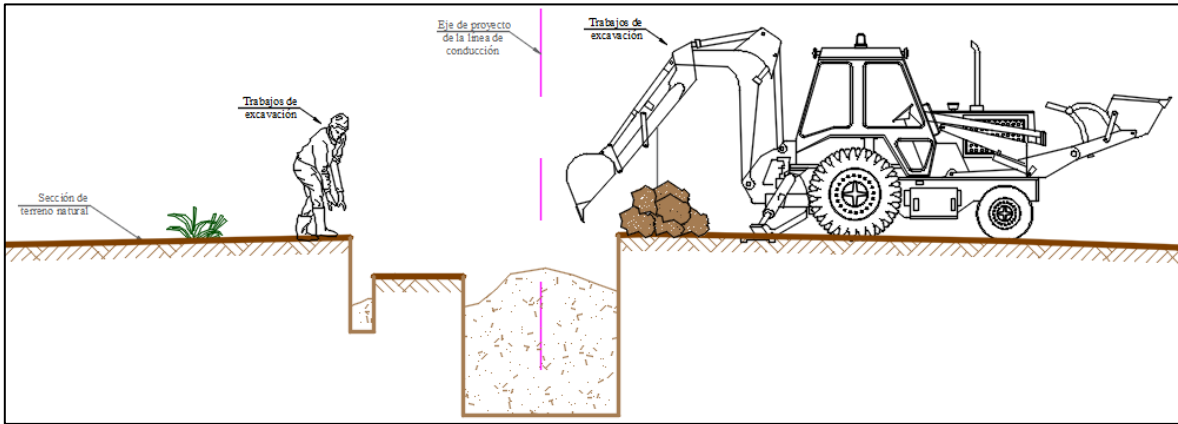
Excavación del canal para alojamiento de tubería y cableado eléctrico.
